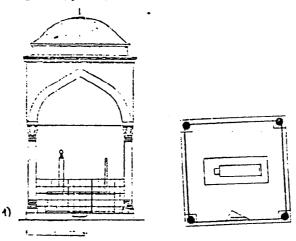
مسقط أفقى لتربة شاهزاده محمد باستانبول (عن : اصلان ابا) .
